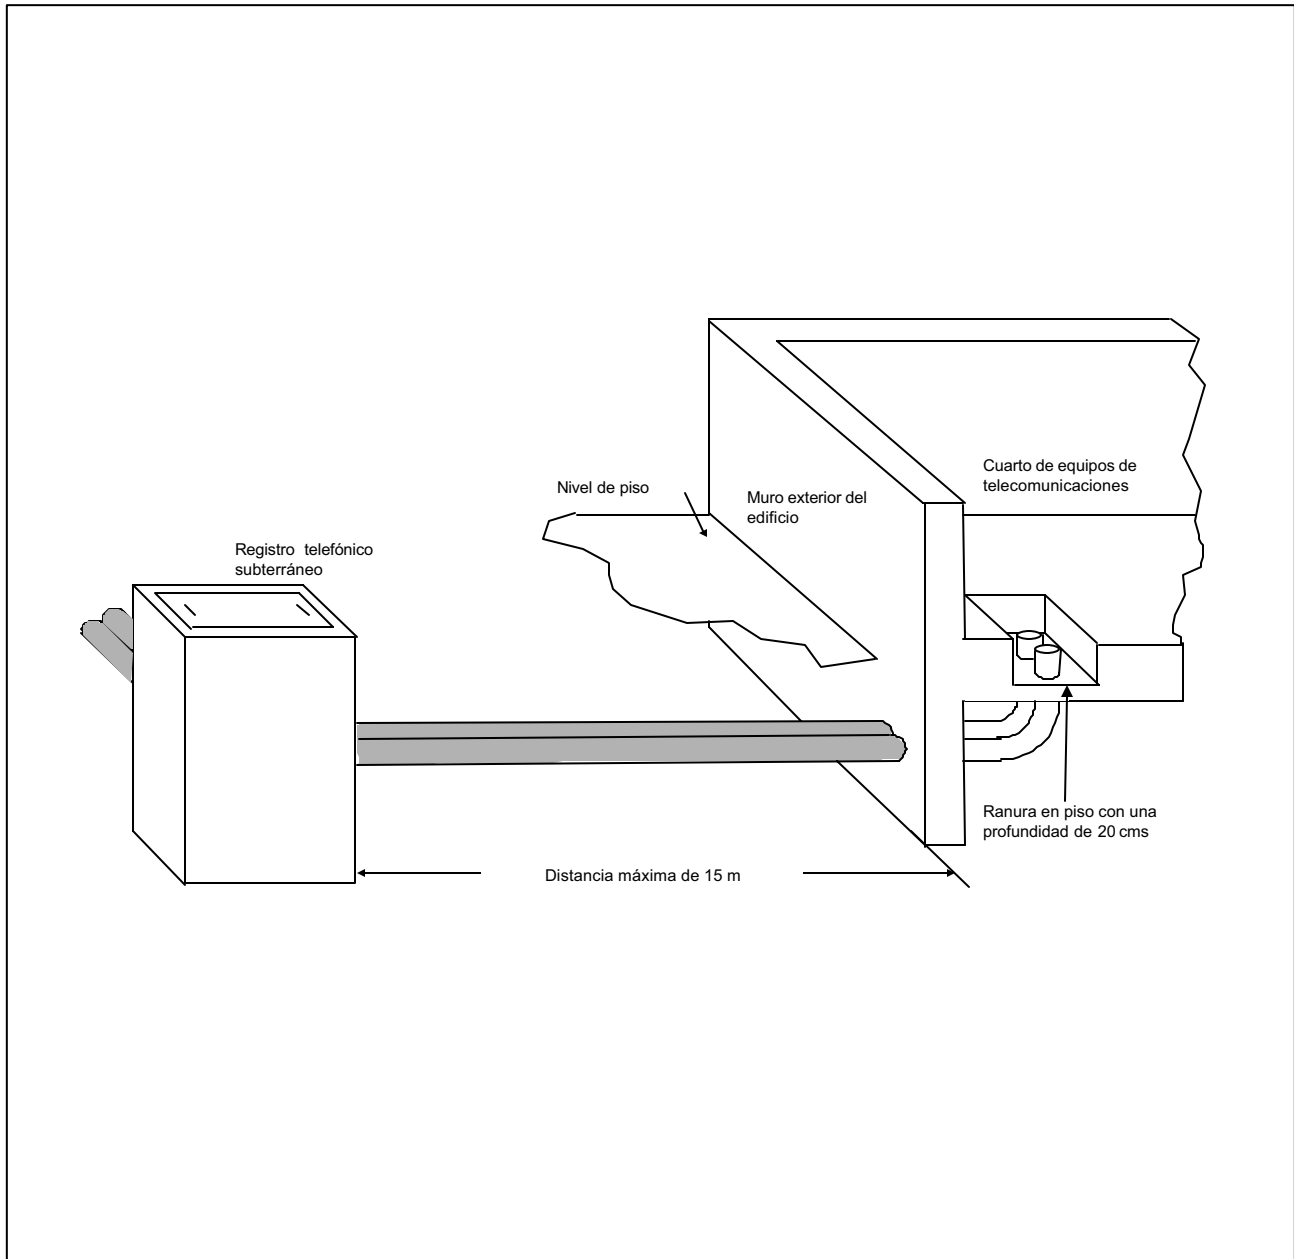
Detalle tipo B para acometida a edificio.
